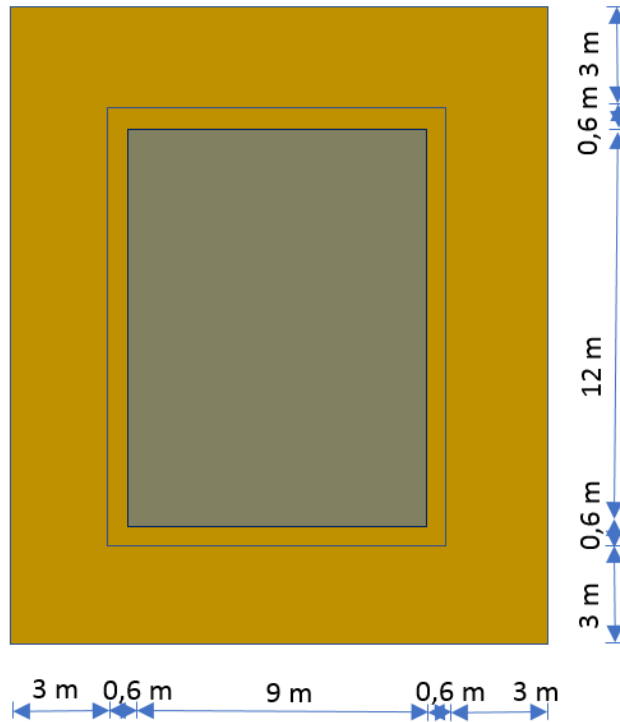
Baugrubenaushub eines Einfamilienhauses – Grundriss
